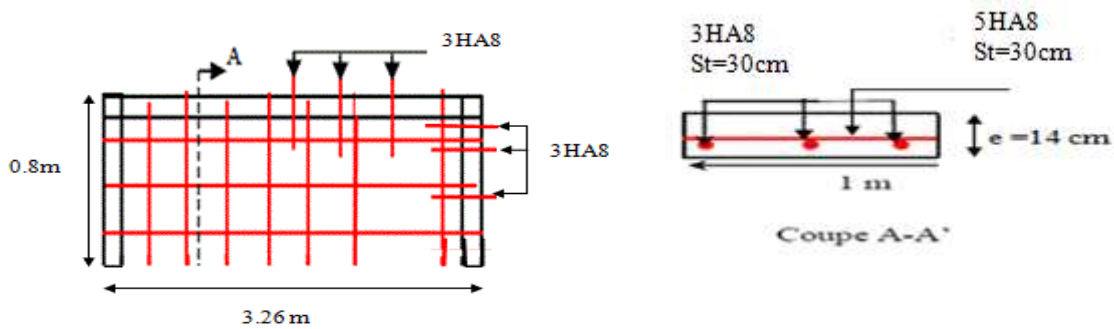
Schéma de ferrailage de la dalle sur trois appuis D3
